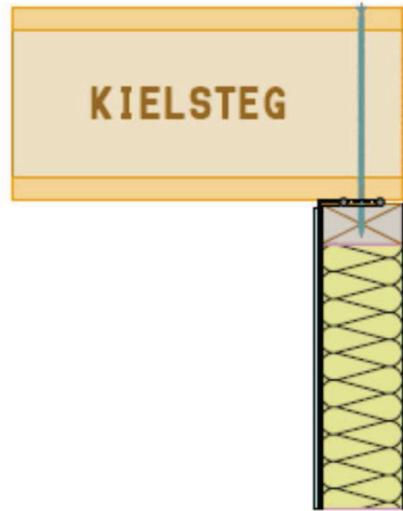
f. Detalle de apoyo del panel. ⁽¹¹⁾
